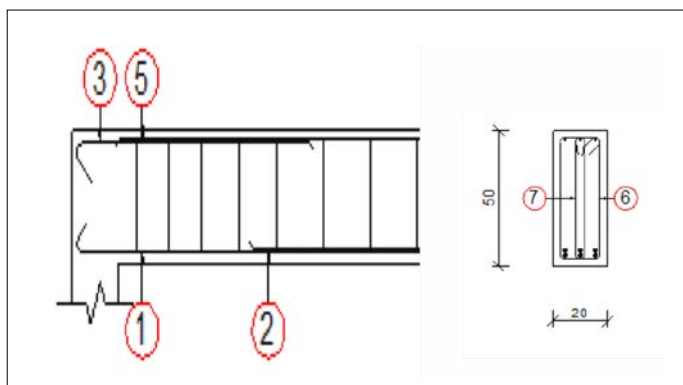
/3 : Exemple de plan de ferrailage difficilement reconstituable par investigation (étriers 7 par exemple)
